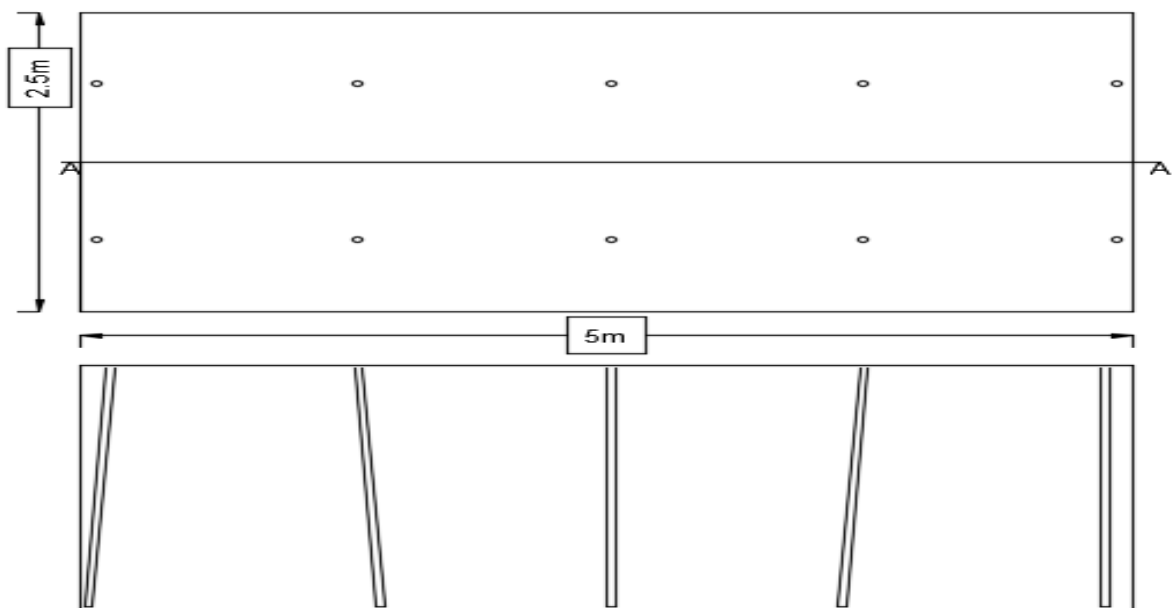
plan de tir de la méthode de tranché montantes remblayée
